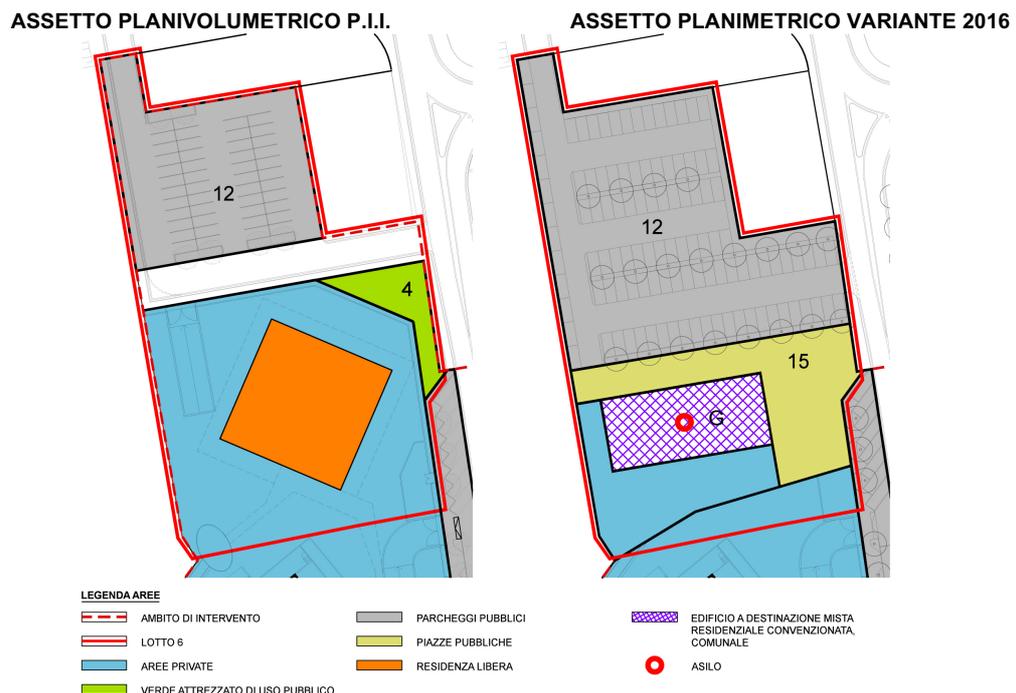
| Lotto 6: confronto tra la planimetria di P.I.I. e variante 2016.
